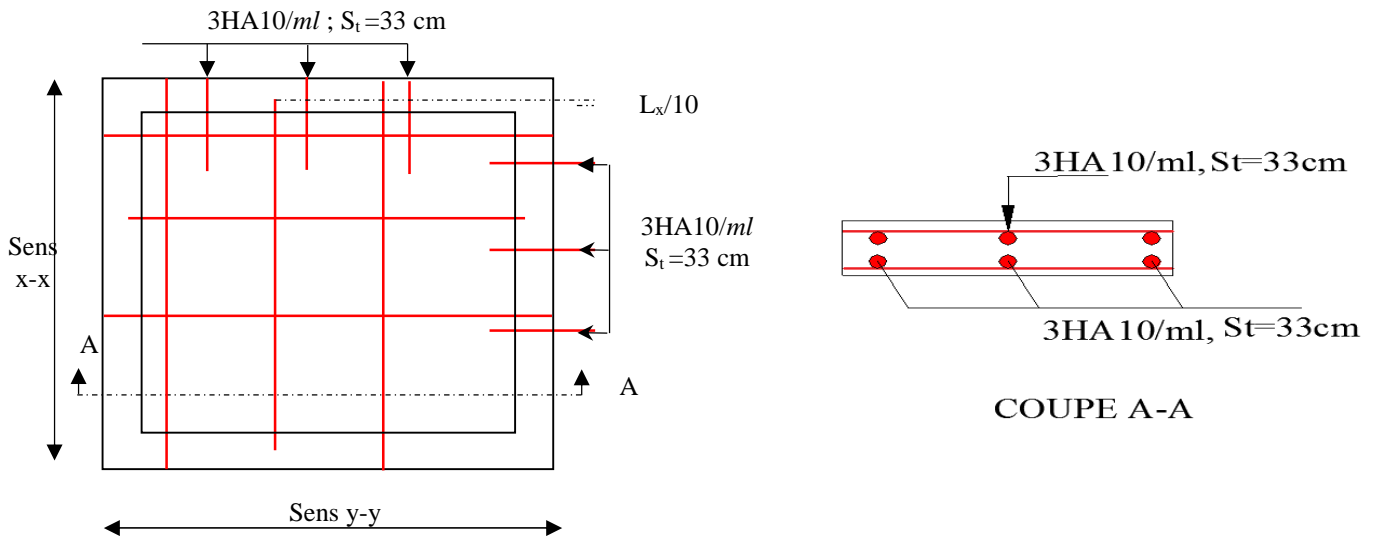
Schéma de ferrailage la dalle pleine au-dessous de l'ascenseur.
